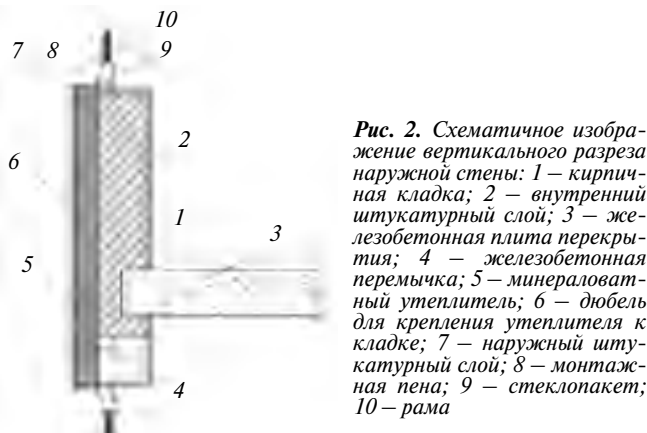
Схематичное изображение вертикального разреза наружной стены: 1 – кирпичная кладка; 2 – внутренний штукатурный слой; 3 – железобетонная плита перекрытия; 4 – железобетонная перемычка; 5 – минераловатный утеплитель; 6 – дюбель для крепления утеплителя к кладке; 7 – наружный штукатурный слой; 8 – монтажная пена; 9 – стеклопакет; 10 – рама
